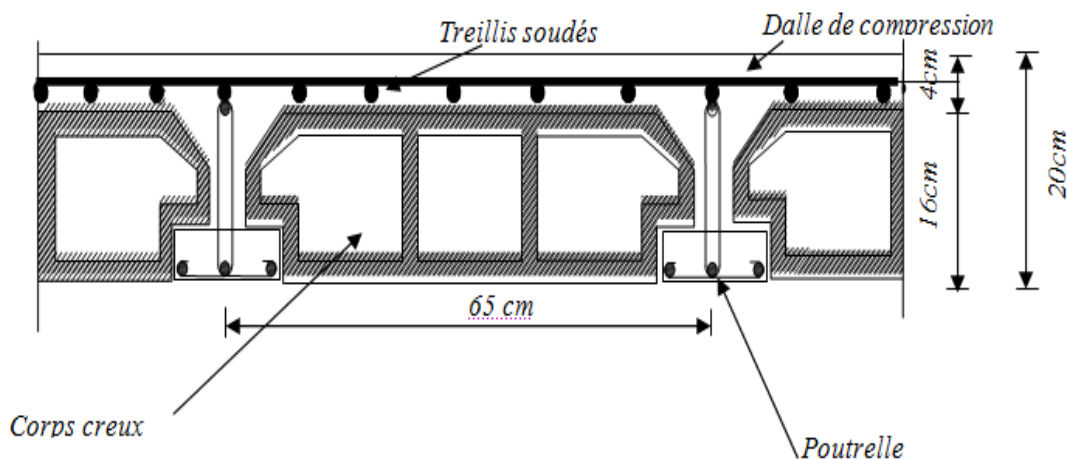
Coupe transversale d'un plancher en corps creux.
